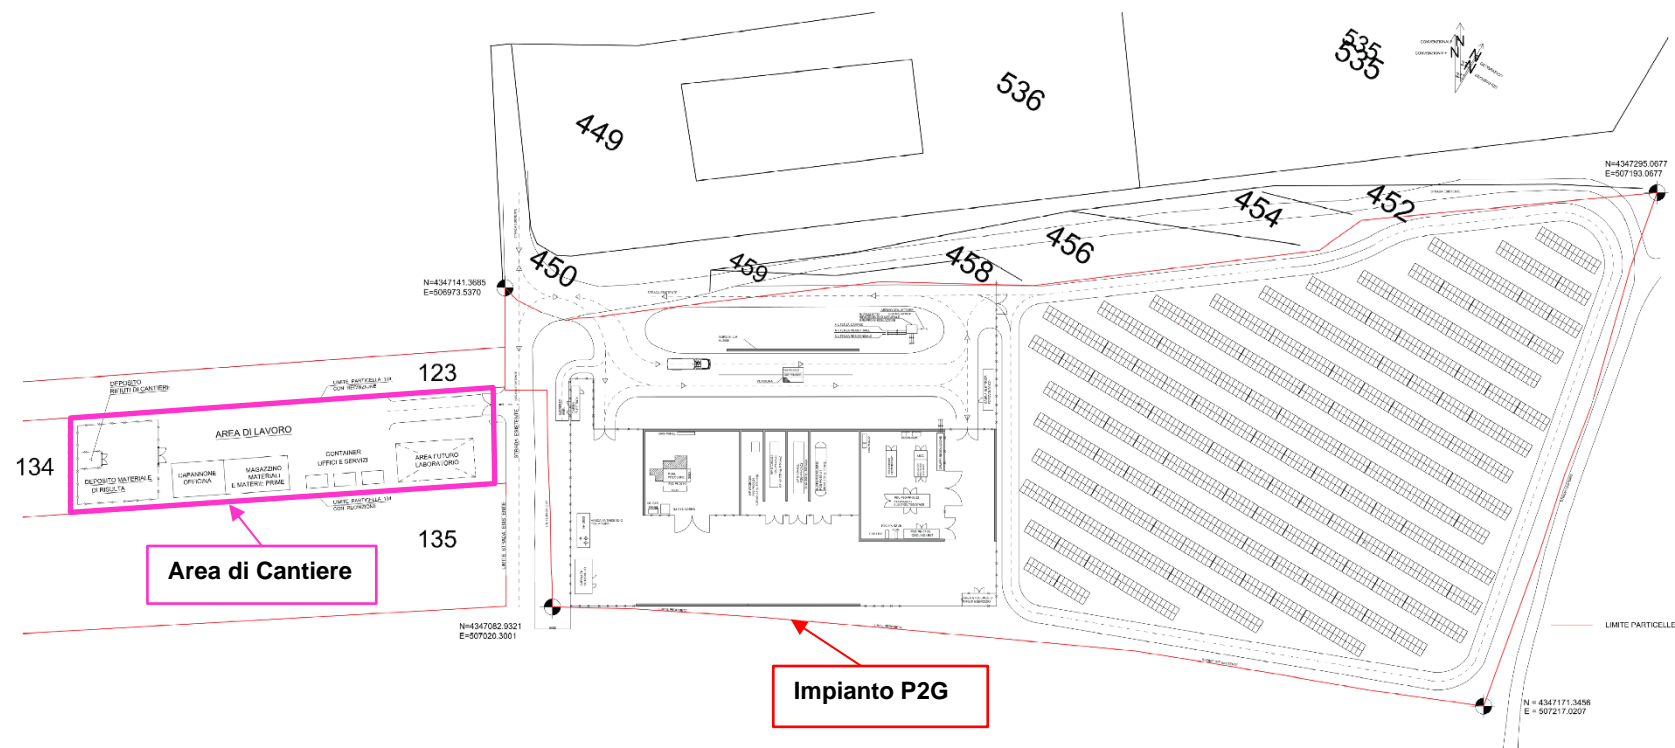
Dettaglio dell'Area di realizzazione dell'Impianto P2G e dell'Area di Cantiere
